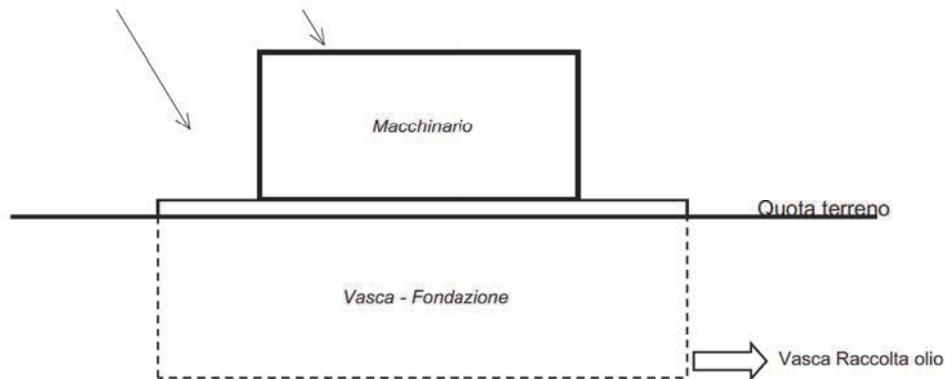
Rappresentazione schematica del sistema Vasca-Fondazione
